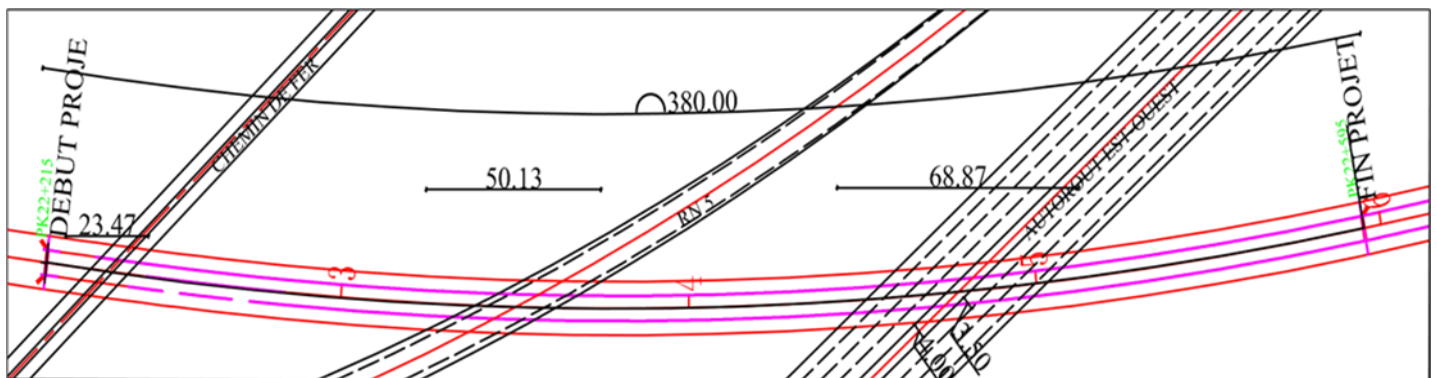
Tracé en plan de l'ouvrage (1:2000)
